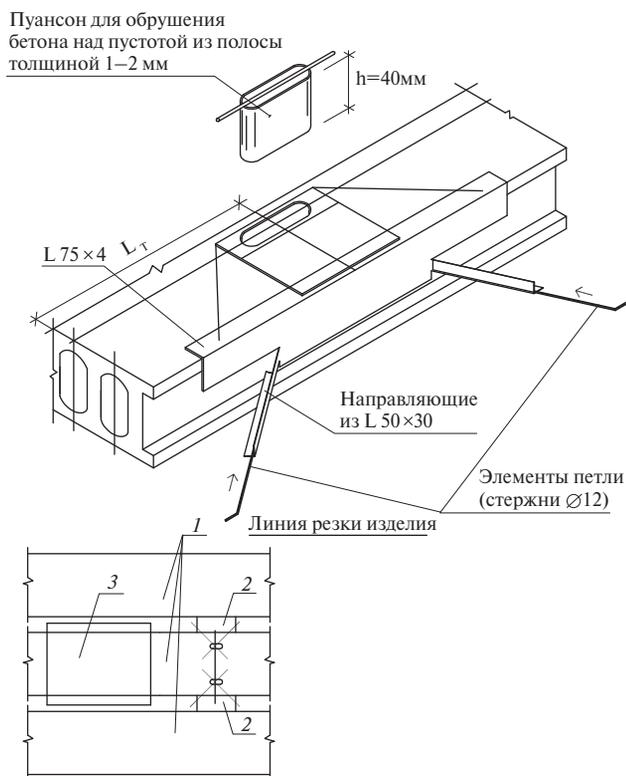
Кондуктор для установки стержней КП: 1 – плиты перекрытия; 2 – шаблон; 3 – бетоноукладчик
